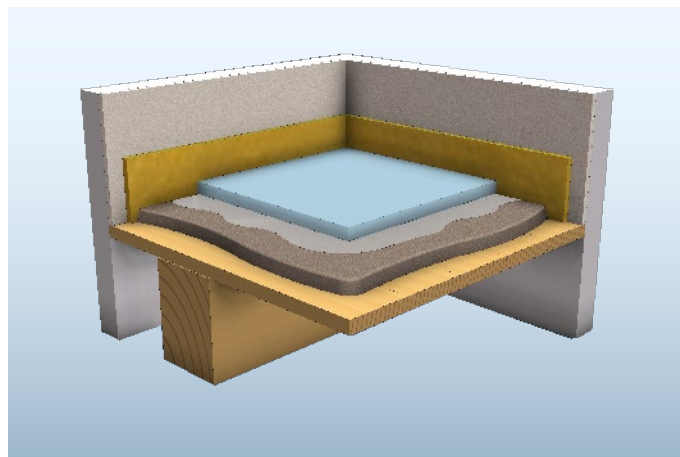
Chape sur un plafond de poutres en bois avec le mortier d'égalisation léger Knauf EPO
